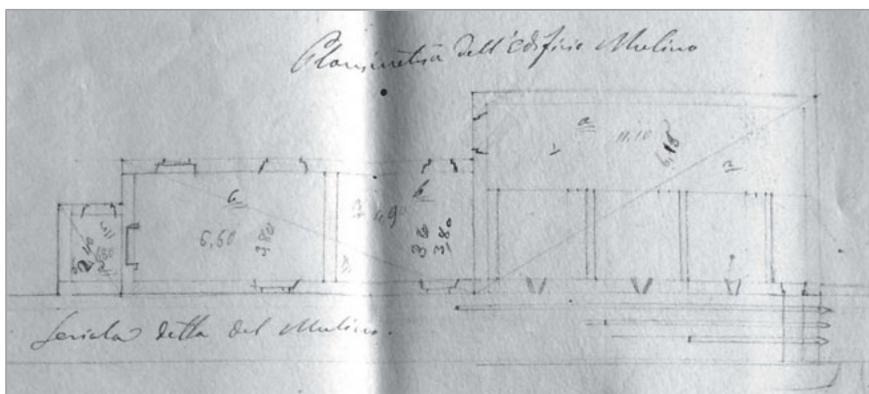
Planimetria del pianoterra del mulino sul Naviglio eseguita dall'ingegner Paolo Chiodi nel 1830.
